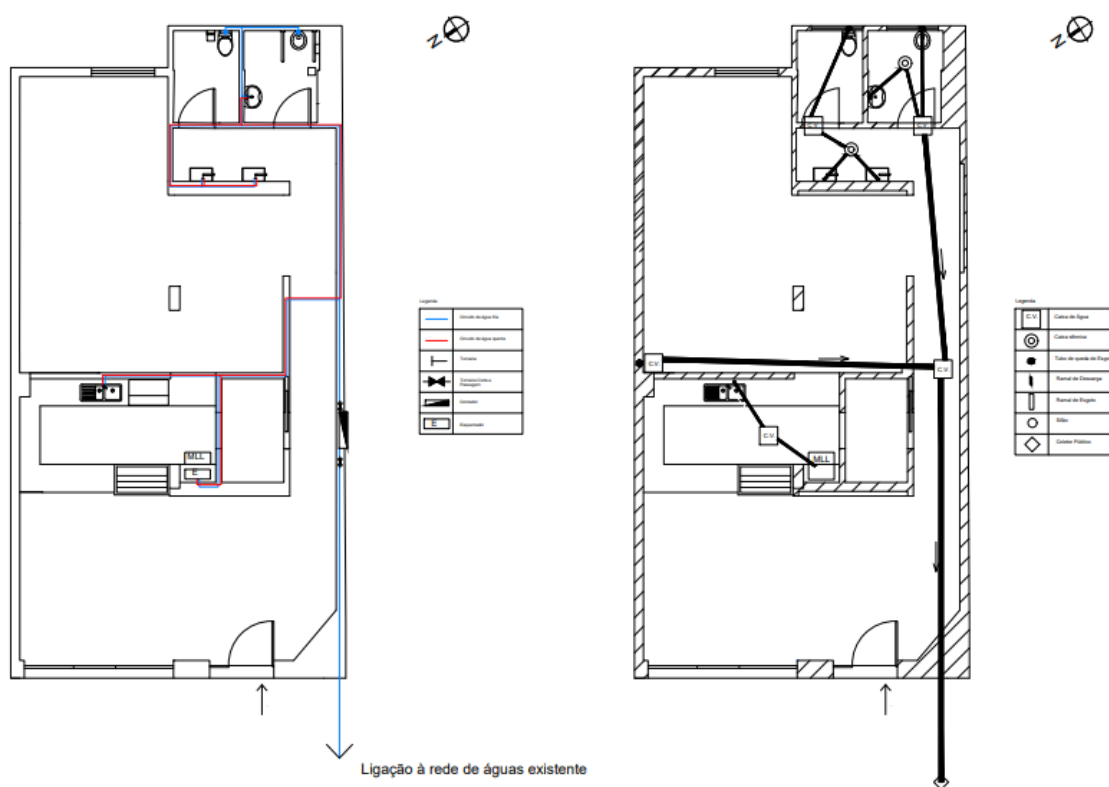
Planta de rede de águas e Planta de esgotos, respetivamente. Fonte: Rafael Costa
